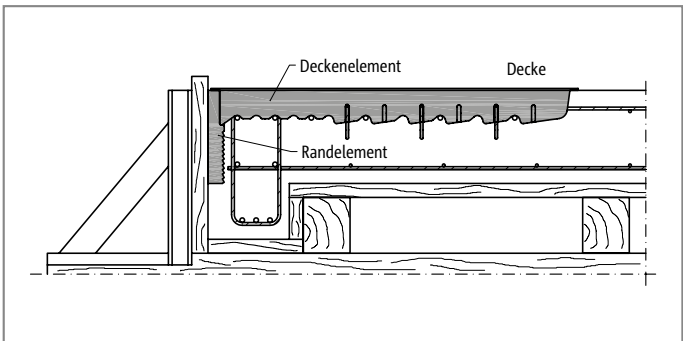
Schöck IDock® 2: Randunterzug als Auflager; die Deckenaussparung wird durch die beiden Elemente Randelement und Deckenelement abgeschalt
